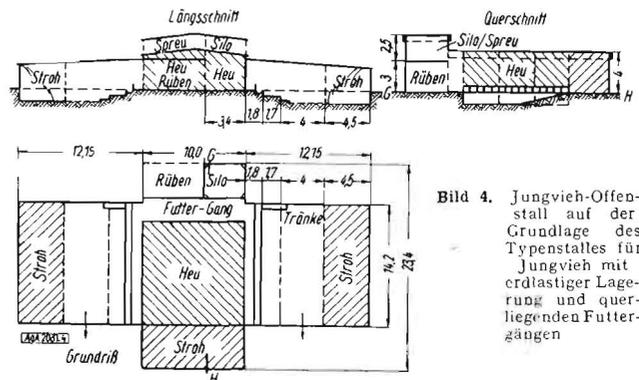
Jungvieh-Offenstall auf der Grundlage des Typenstalles für Jungvieh mit erdlastiger Lagerung und querliegenden Futtergängen
